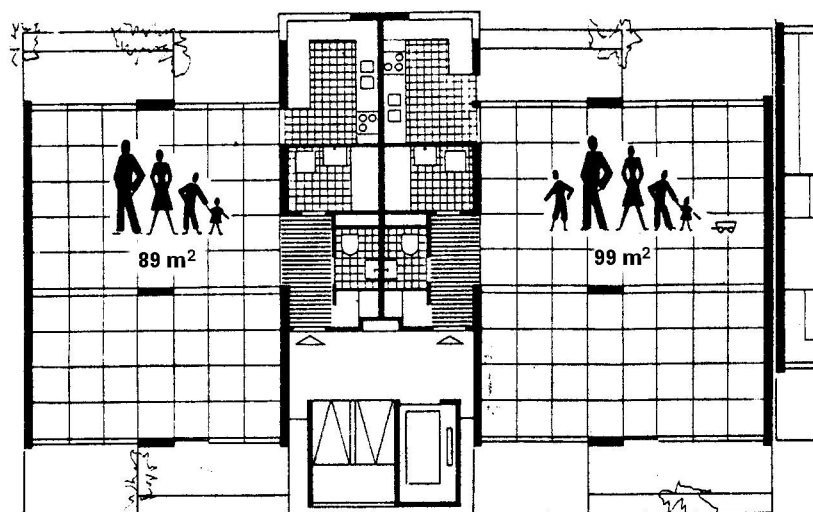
Concepção que prevê separação entre áreas secas e molhadas e estrutura com laje apoiada apenas em pilares sem vigamentos; projeto realizado em Ulm-Wimblingen, Alemanha, 1973 (Fontes: 12 VARIATIONEN, 1979; TRIEBEL, 1980; SCHNEIDER, 1998)
